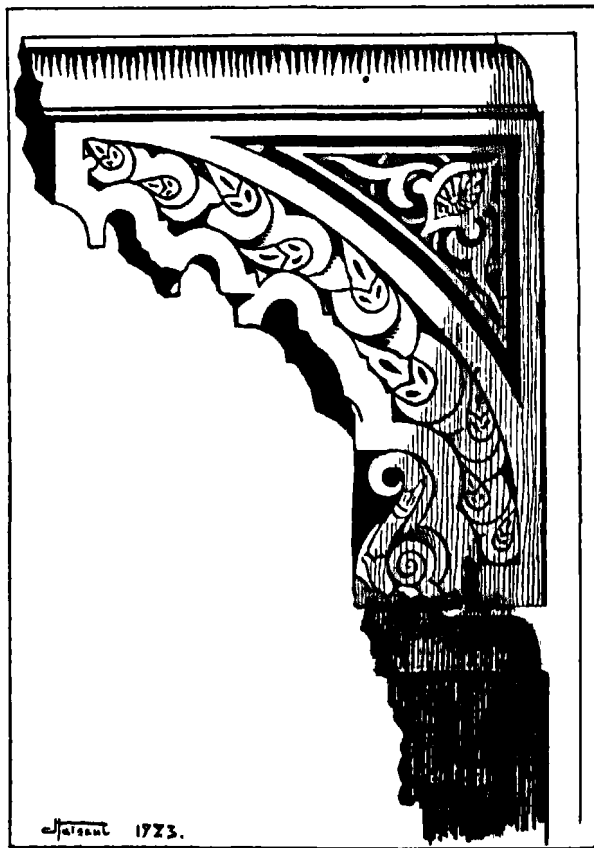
Porte de Chetha. Façade extérieure : console de droite.
